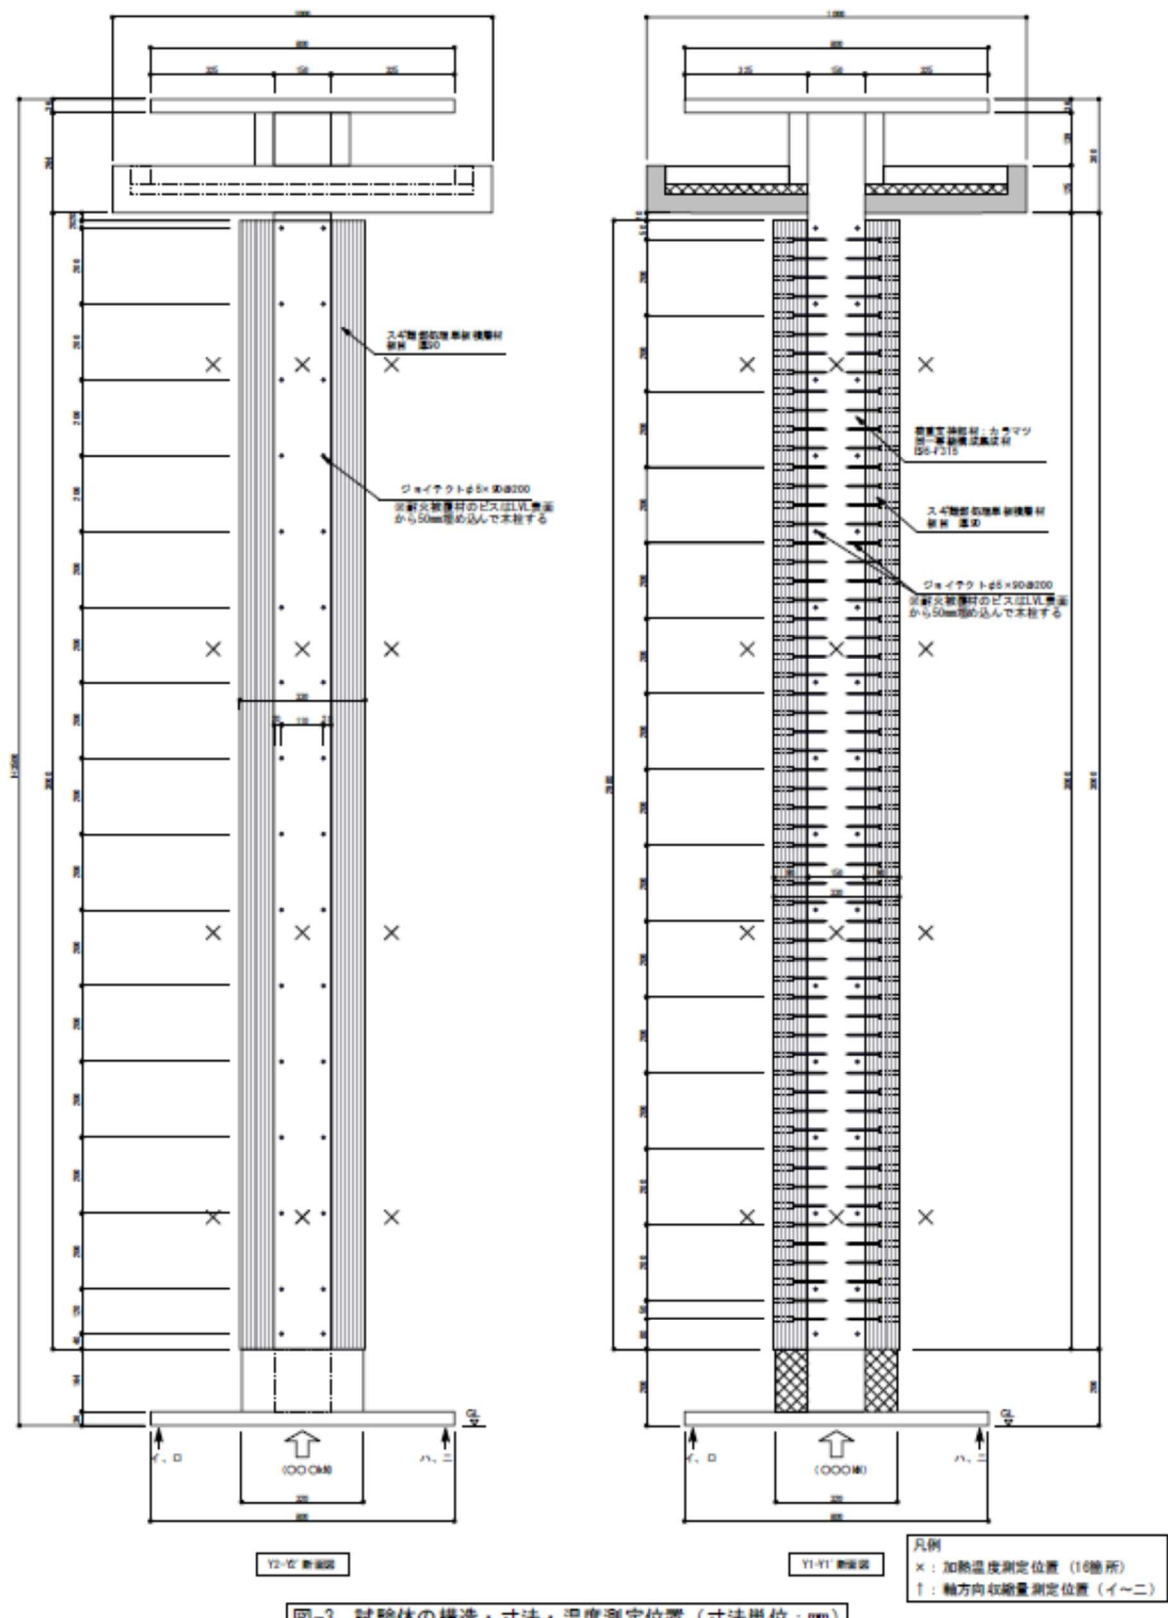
試験体の構造・寸法・温度測定位置 (寸法単位: mm)
